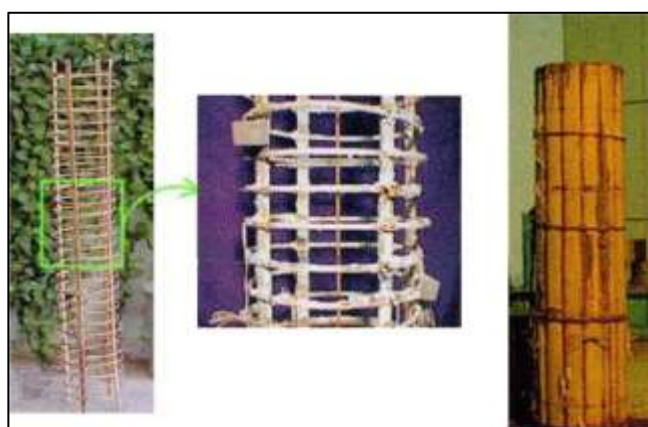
Pilar Cilíndrico armado e cofrado em bambu [30]
